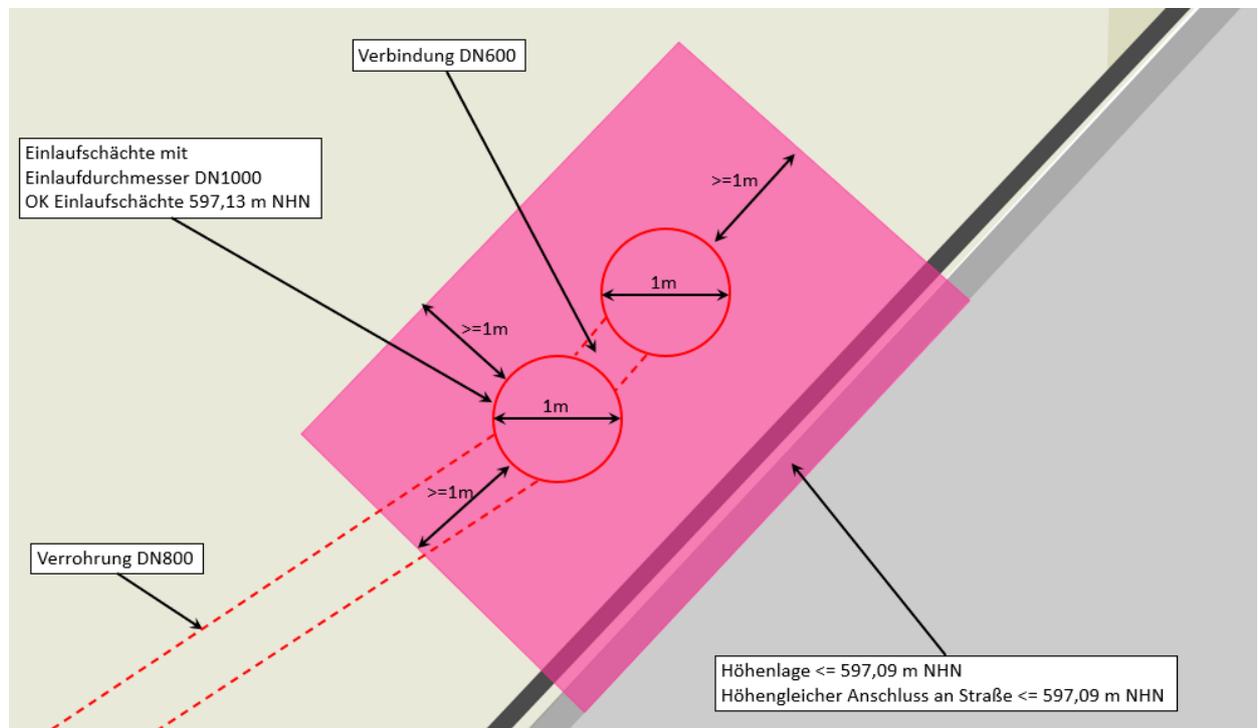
Angepasster Planungszustand, Mindestabmessungen Einlaufbereich (Plangrundlage: Ingenieurbüro mahl gebhard konzepte, München)
